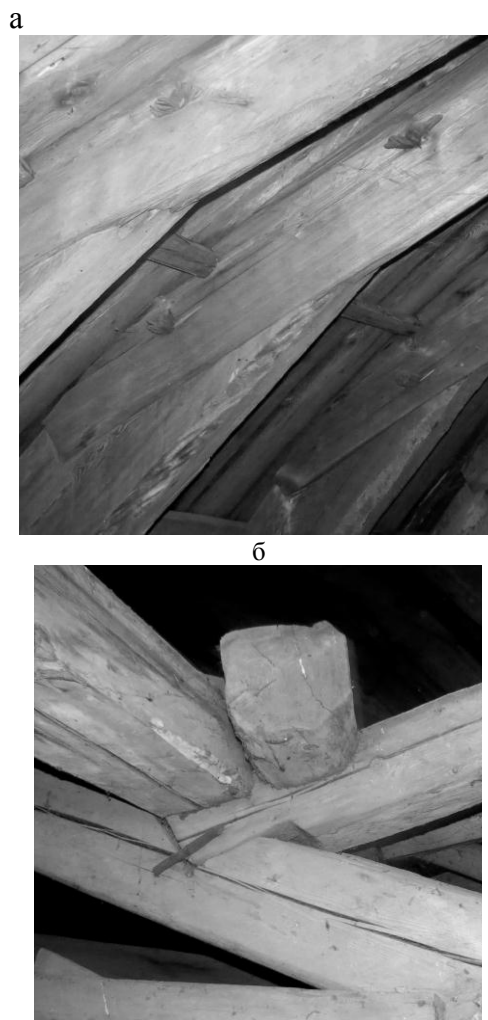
Узлы соединения типовых элементов стропильных конструкций
